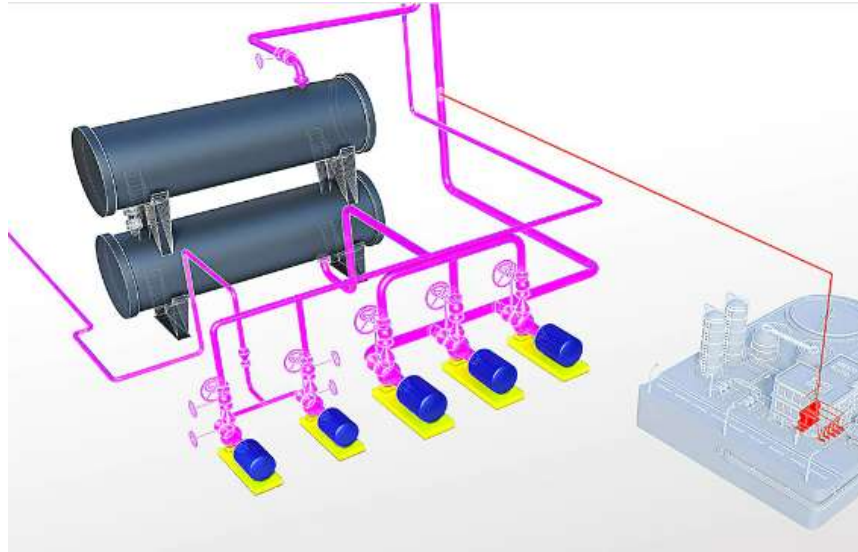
Planta diseñada mediante el conjunto de herramientas Plant 3D.
